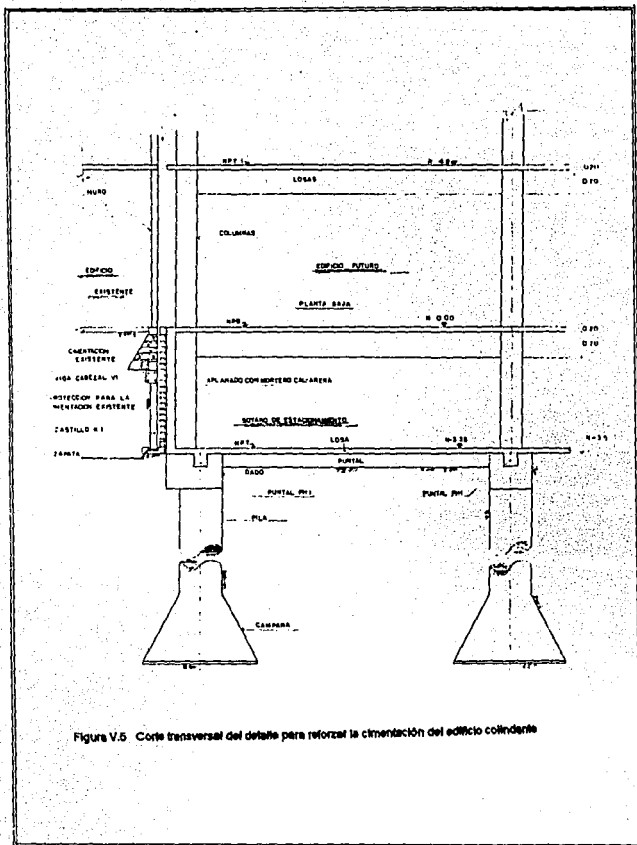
Corte transversal del detalle para reforzar la cimentación del edificio colindante
